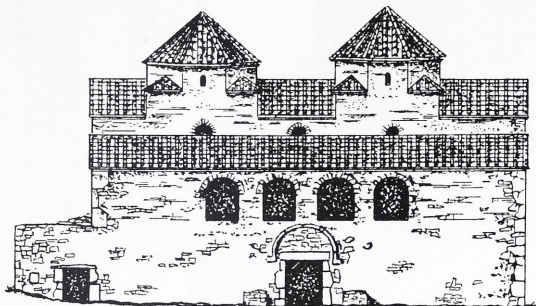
Gurdshani, Kirche Kwela Zminda, Ansicht von Süden mit rekonstruierten Galeriebögen
